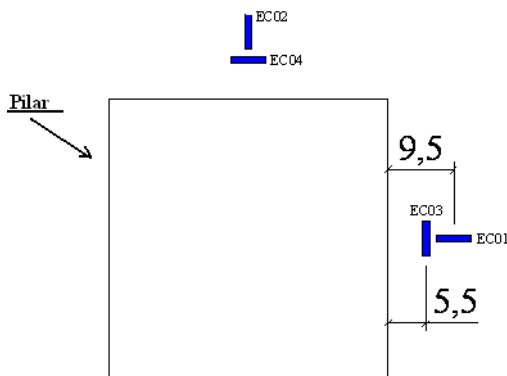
Extensometria no concreto dos modelos L0-01, LC-S1 e LC-S2
